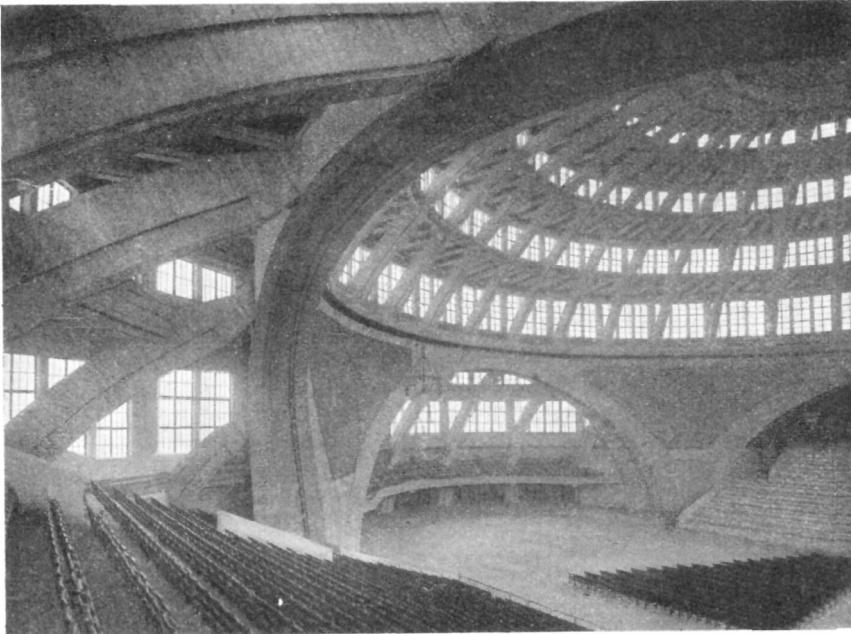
Jahrhunderthalle zu Breslau. Innenansicht
